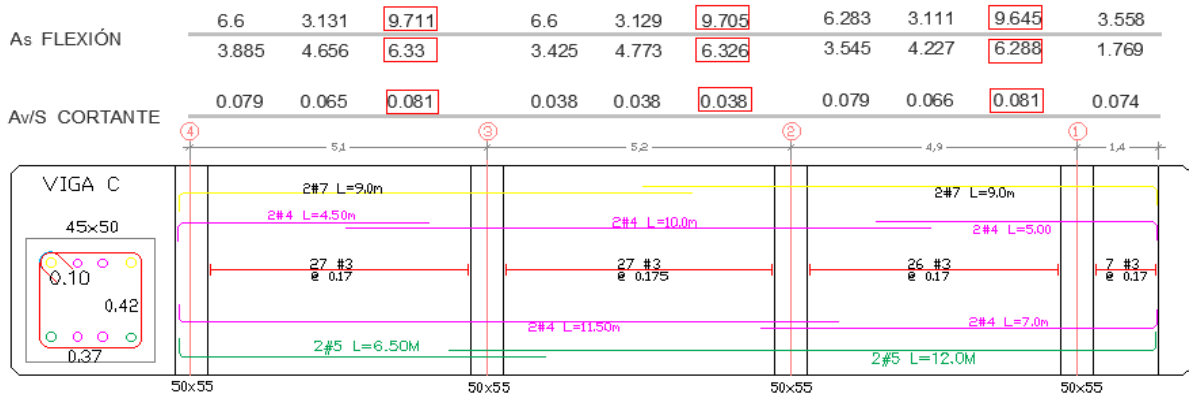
Cuantías obtenidas por esfuerzo a flexión, cortante y despiece de la viga C de la planta estructural. Fuente: elaboración propia.
